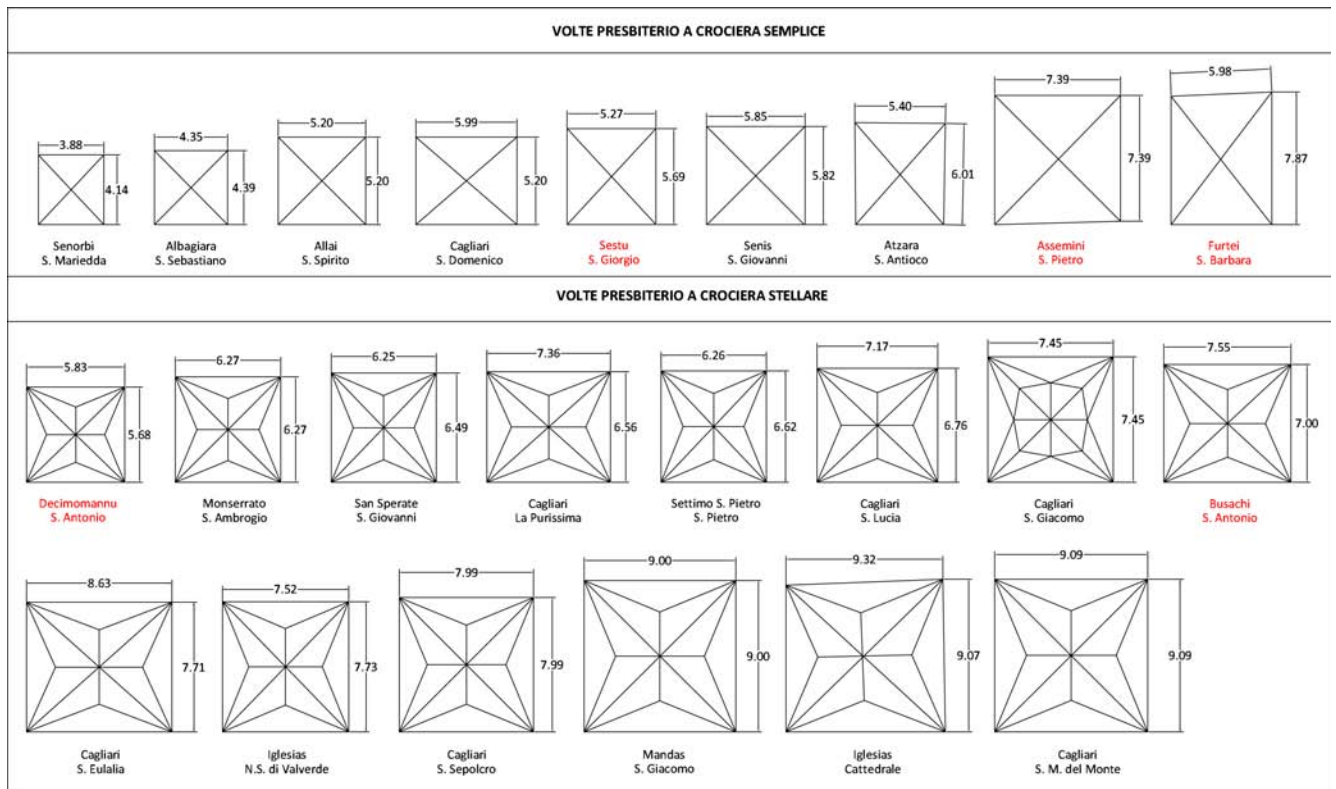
Casistica delle volte su pianta rettangolare suddivise per proporzione tra i lati. In rosso gli edifici rilevati.
